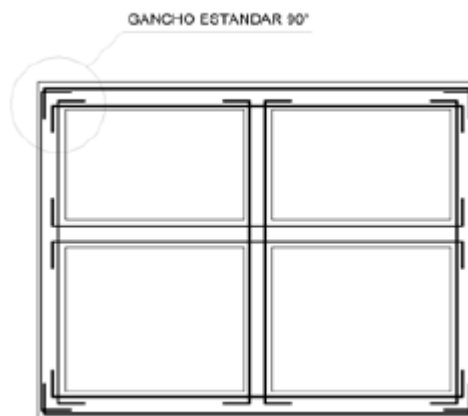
Detalle de anclaje de refuerzo longitudinal en vigas de cimentación
